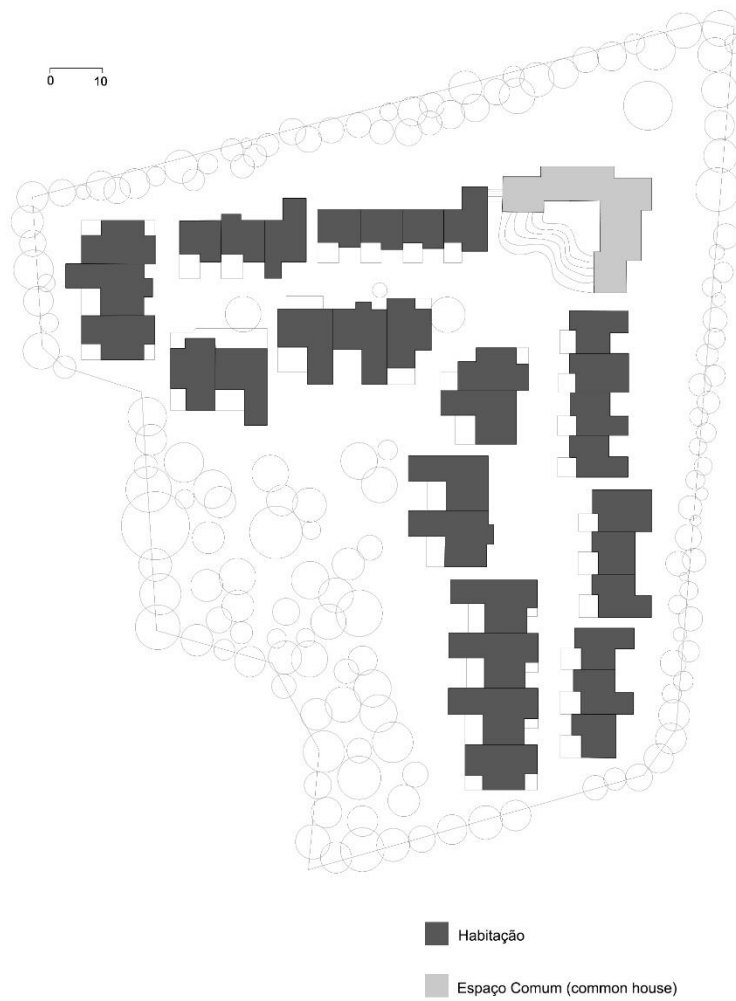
Planta de implantação de Trudslund, escala 1.1000 . Editado pela autora
